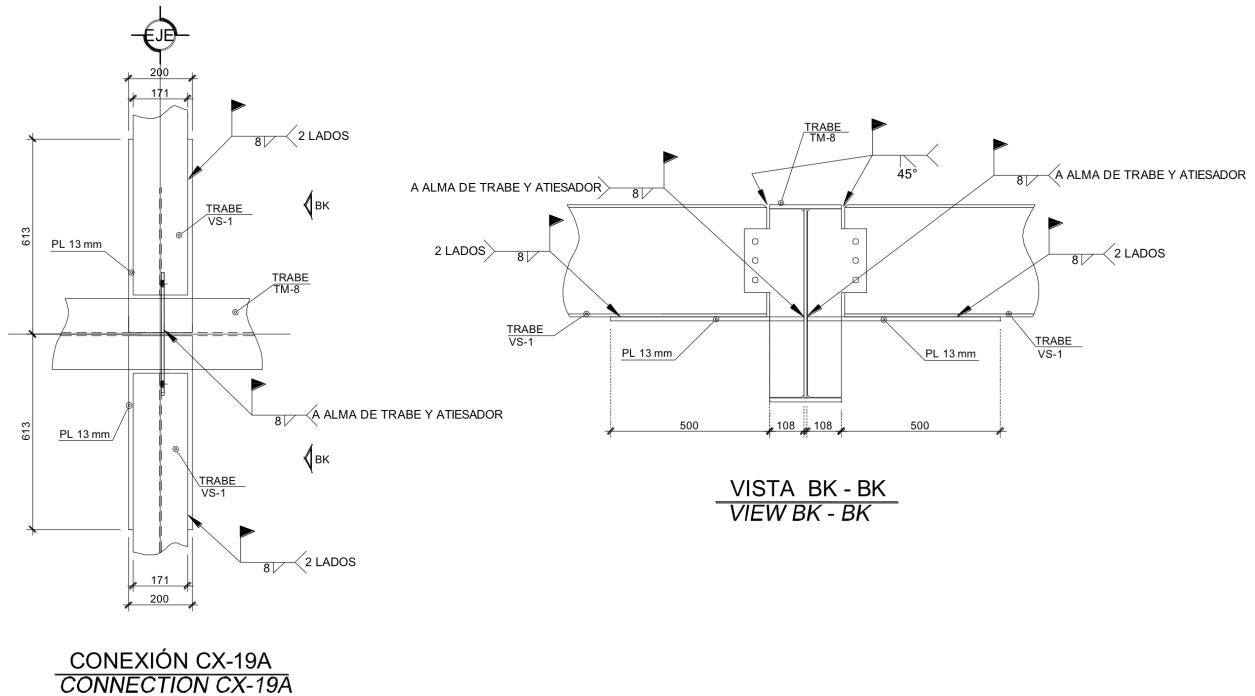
Detalle de conexión simple de viga a trabe en entrepiso
